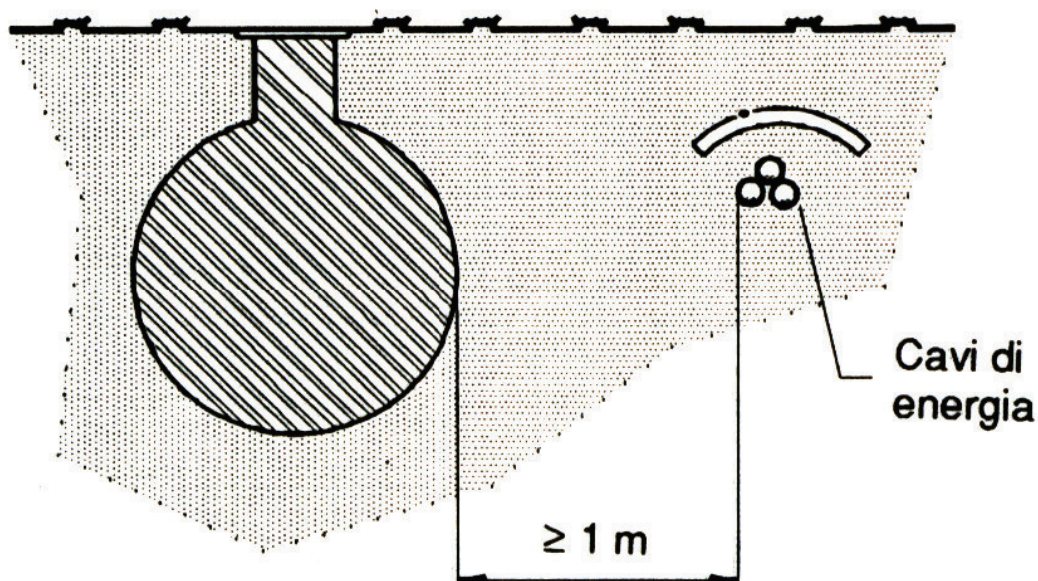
Le connessioni sui cavi devono distare in pianta almeno 1 m dal punto di incrocio con una tubazione metallica.
